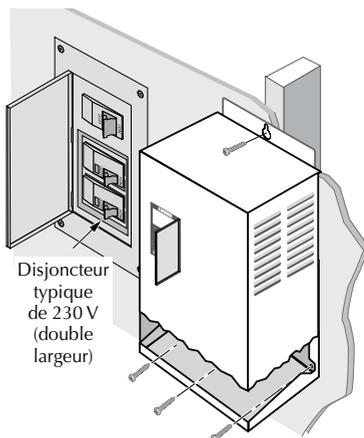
Montage du mécanisme d'entraînement sur un mur
